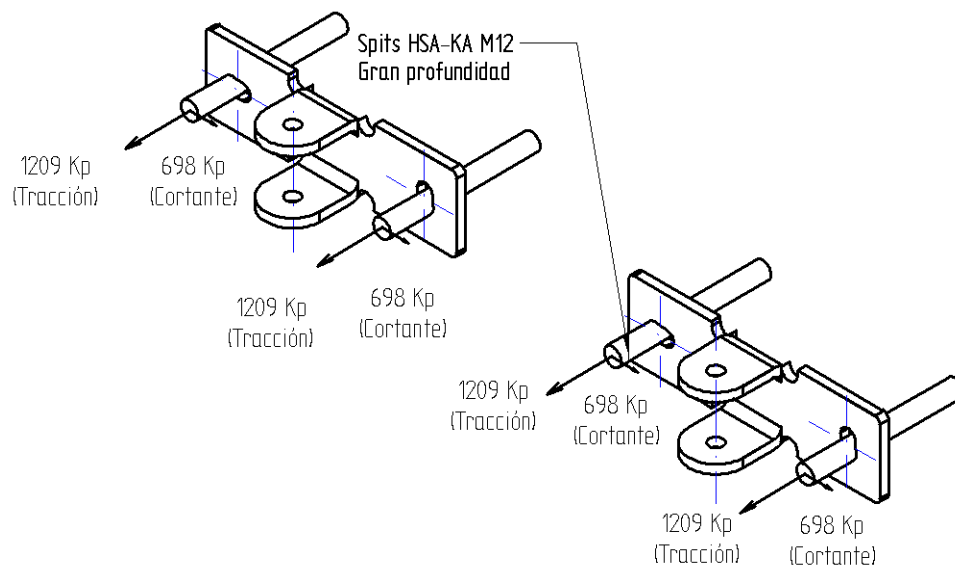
Cargas soportadas por la Brida de Anclaje a Pared
